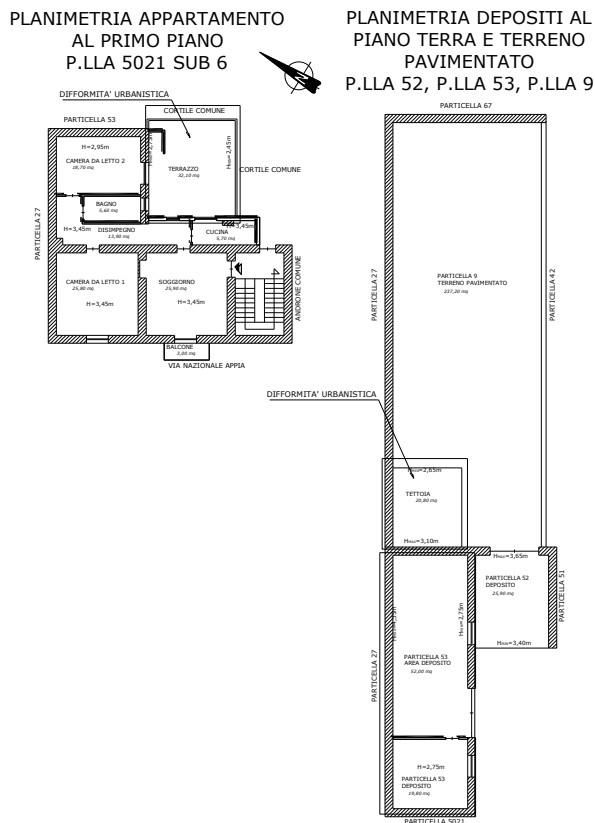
planimetria delle difformità urbanistiche del LOTTO UNICO
